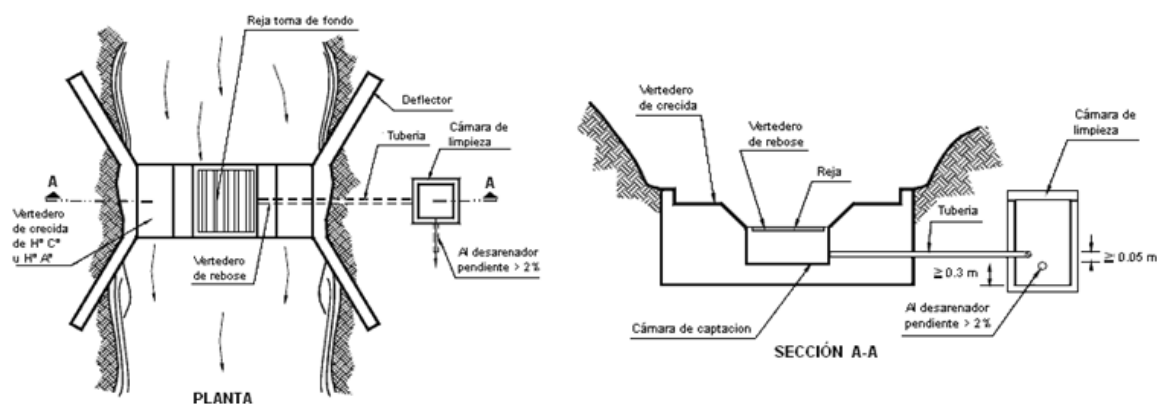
Vista de planta y corte de una toma de fondo. [30]
